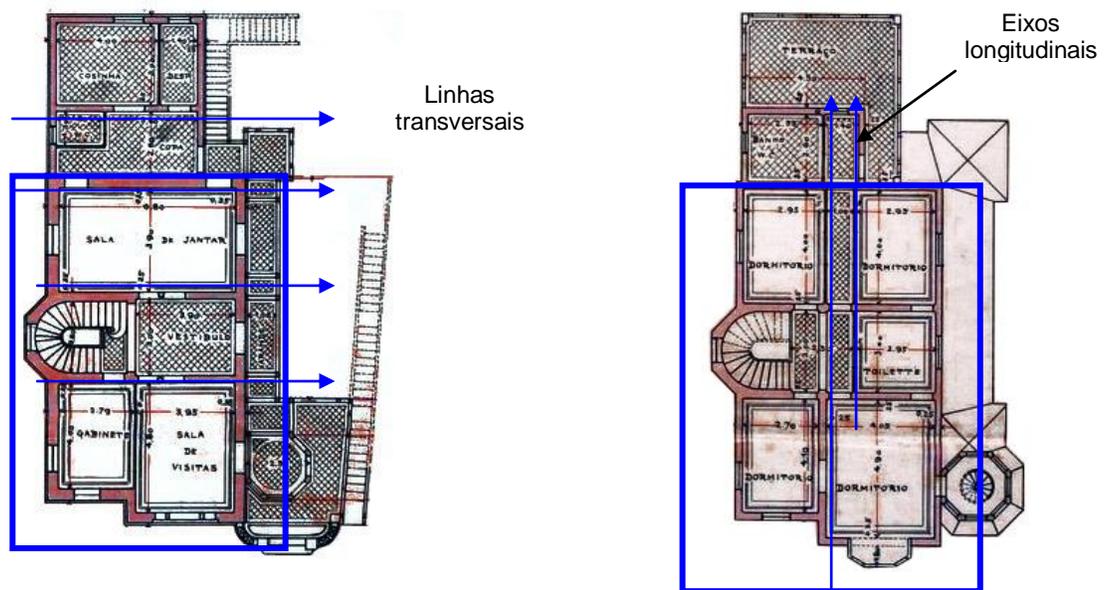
e 161: O retângulo em azul revela o núcleo central do pavimento de acesso que se repetiu no pavimento superior.
